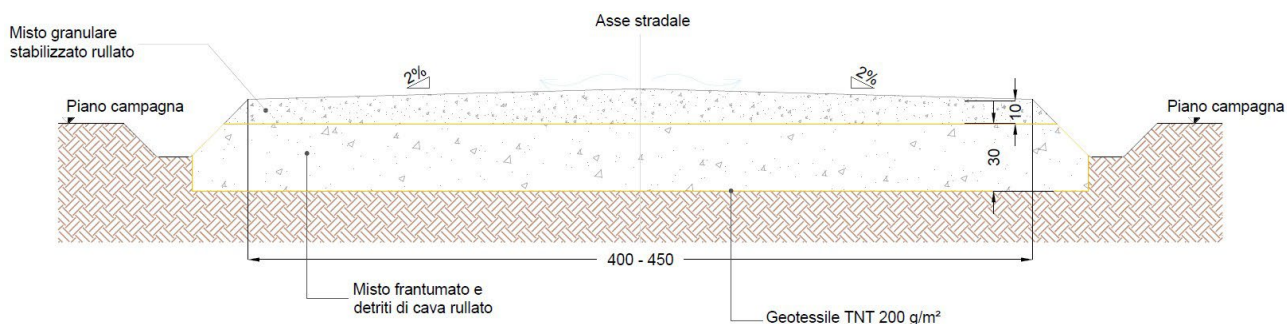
Sezione tipo pista di impianto a livello; misure in centimetri
